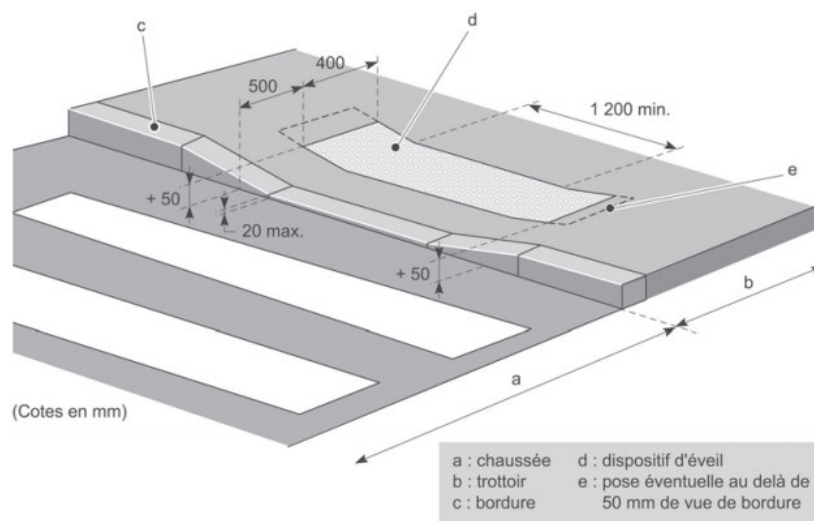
Exemplo de rampeamento de travessia pedonal em França (NF P 98 – 351)
